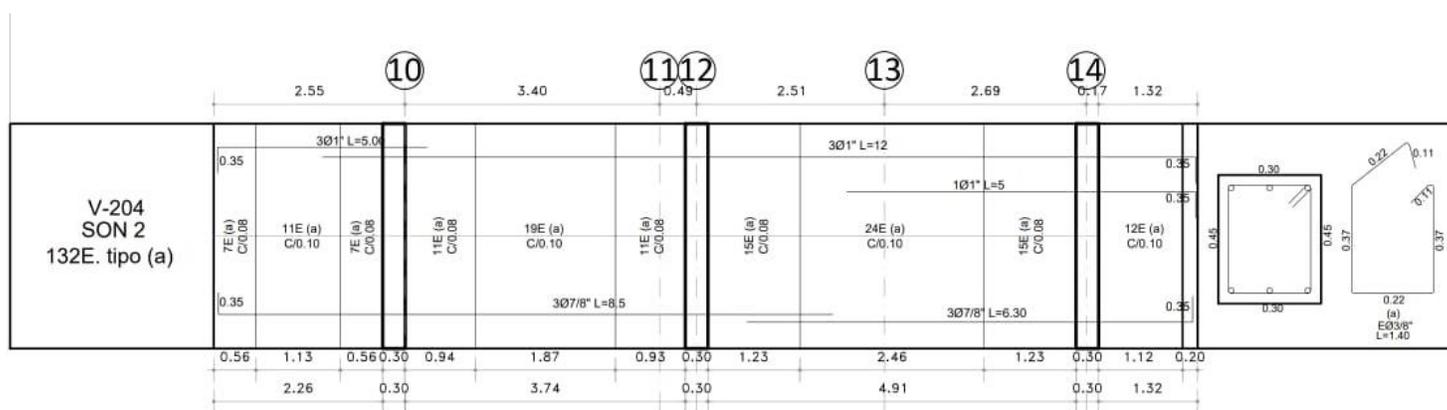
Viga 0.30x0.45 y Sección Estructural 204.
